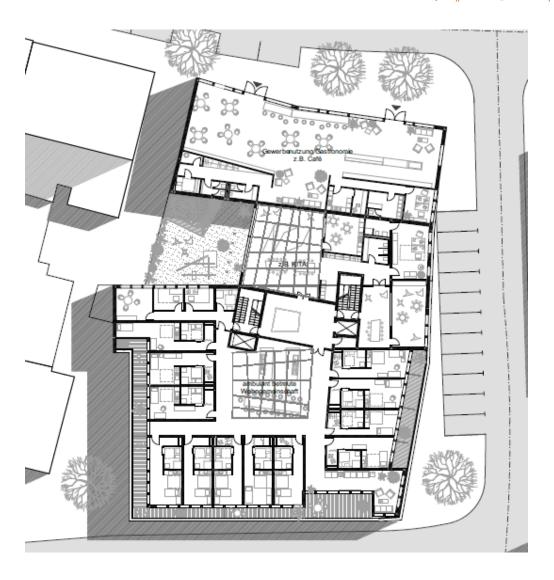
Geplanter Grundriss, Erdgeschoss (Mars-Architekten, 2020)
